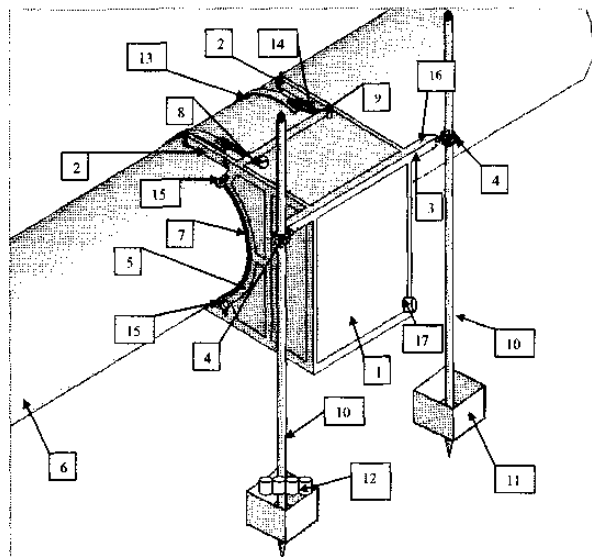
Общий вид специализированного подводного кессона Захарова: корпус – 1; направляющие – 2; крепежный кронштейн – 3; шарнирное устройство – 4; сегментный вырез корпуса – 5; магистральный трубопровод – 6; резиновый уплотнитель – 7; вентиляционные отверстия – 8, 9; штанги-груза – 10; балластные ящики – 11; балластные груза – 12; прижимные полукольца – 13; талрепы – 14; болты-упоры – 15; монтажные петли – 16; выходной штуцер – 17
